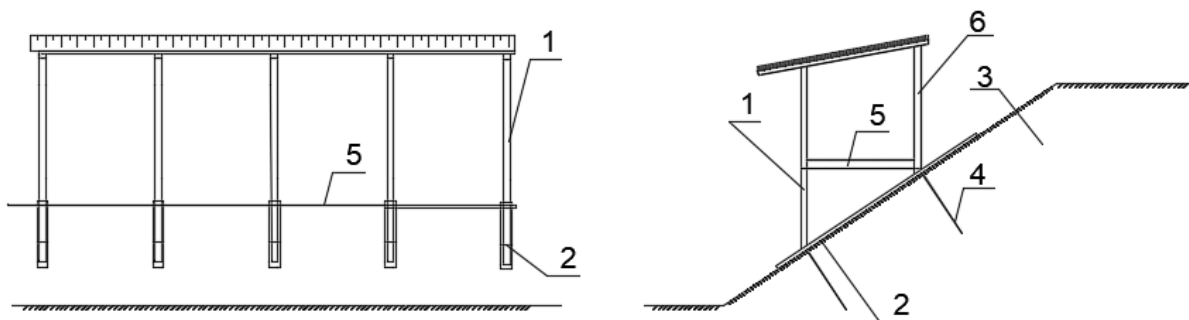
Эскиз велоэстакады для прокладки вдоль насыпи: 1 – поперечные
